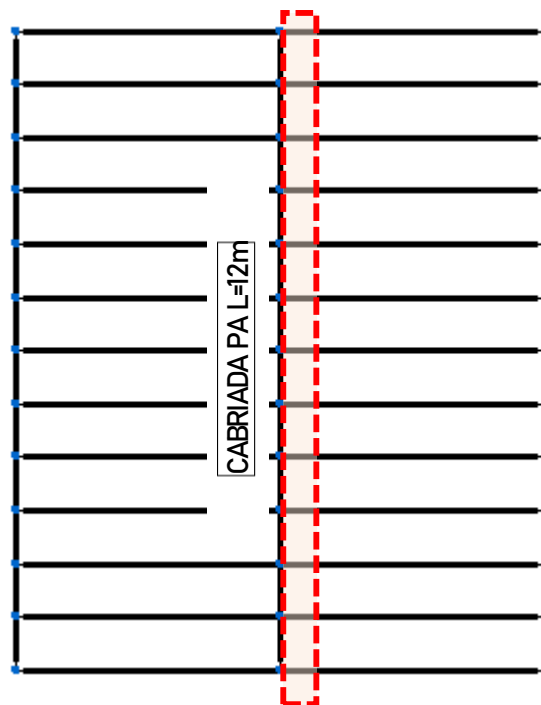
Geometría Modelo CYPE 3D – barras Planta de Techos Techo PA
